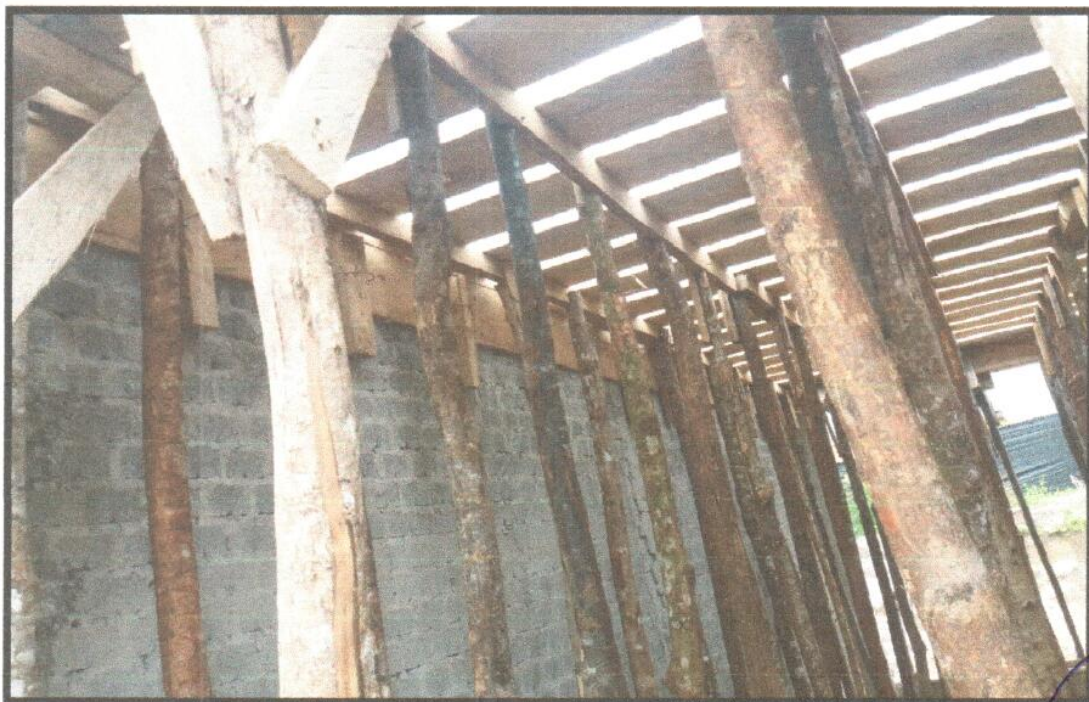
PIE DERECHO, T PARA SOPORTAR LA LOSA ALIGERADA. MODULO 01
